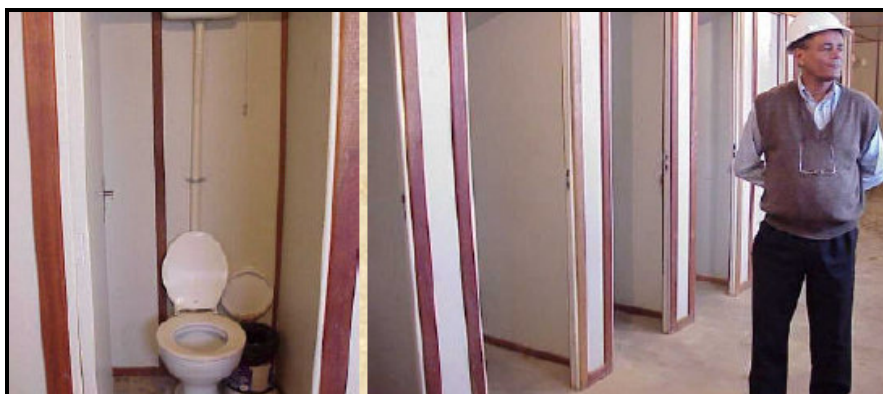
Exemplo de instalações sanitárias de canteiro de obras
